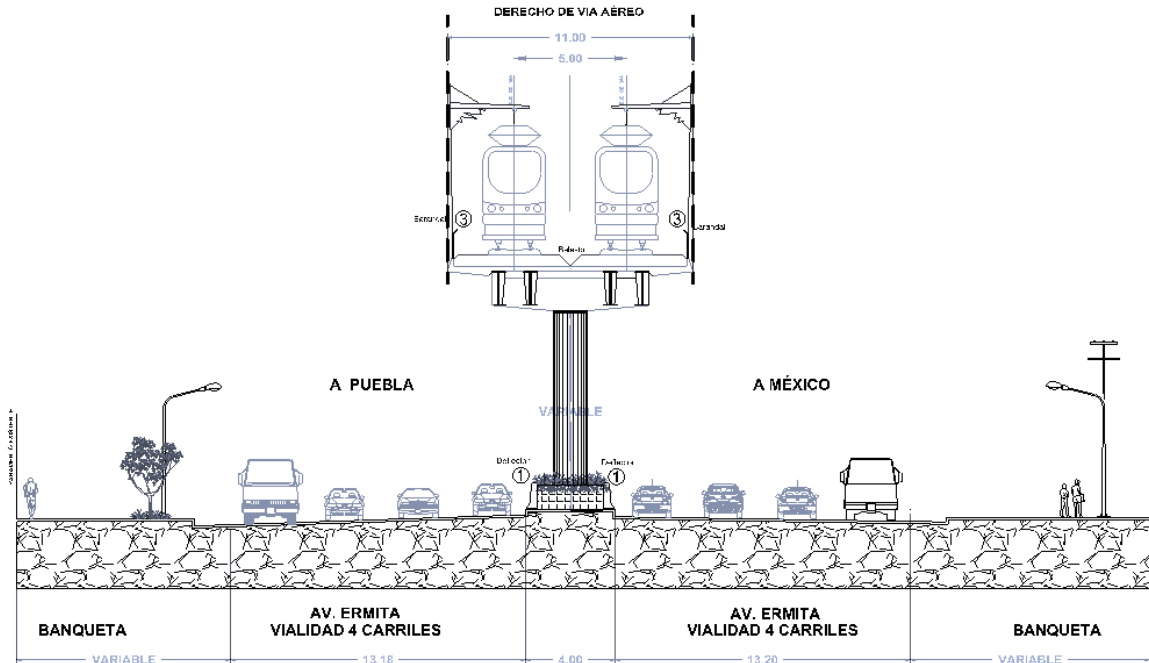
Sección tipo de estructura elevada sobre Ermita - Iztapalapa
